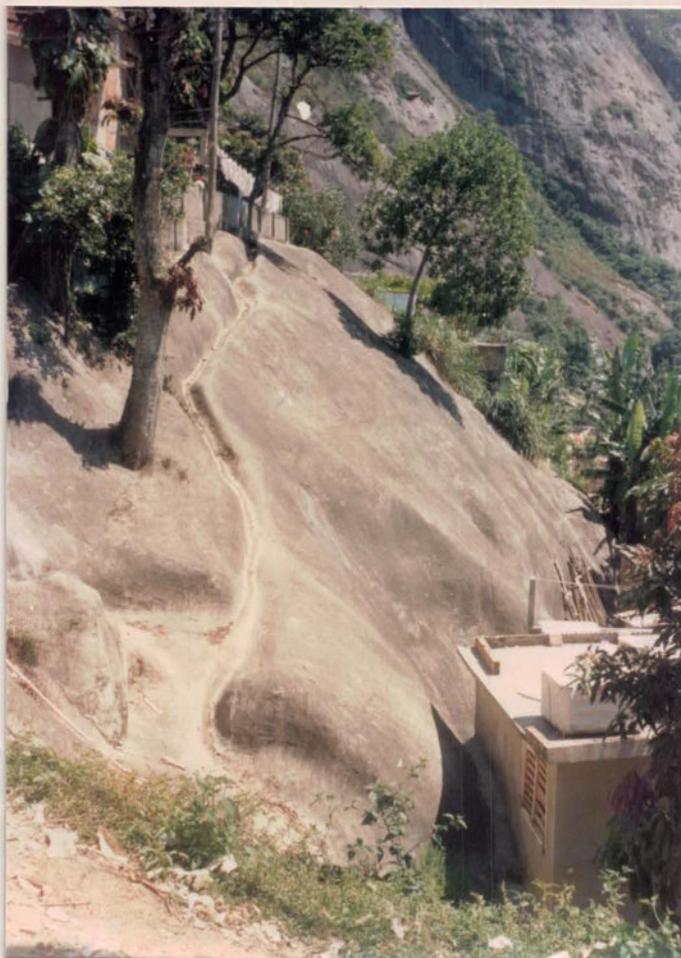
Obra em concreto projetado na Rua 31 de Julho.
